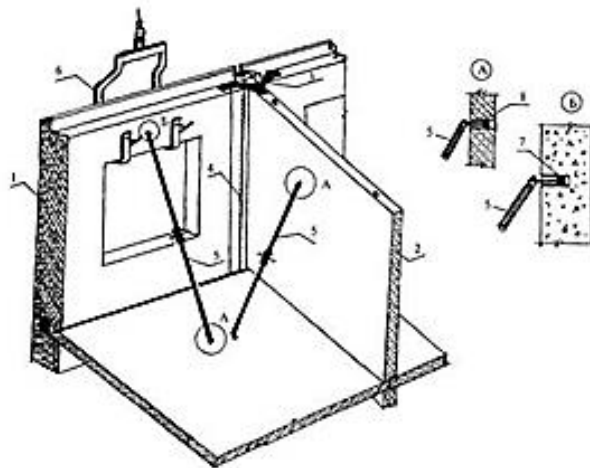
Последовательность поэтапного демонтажа этажа жилого панельного здания.
